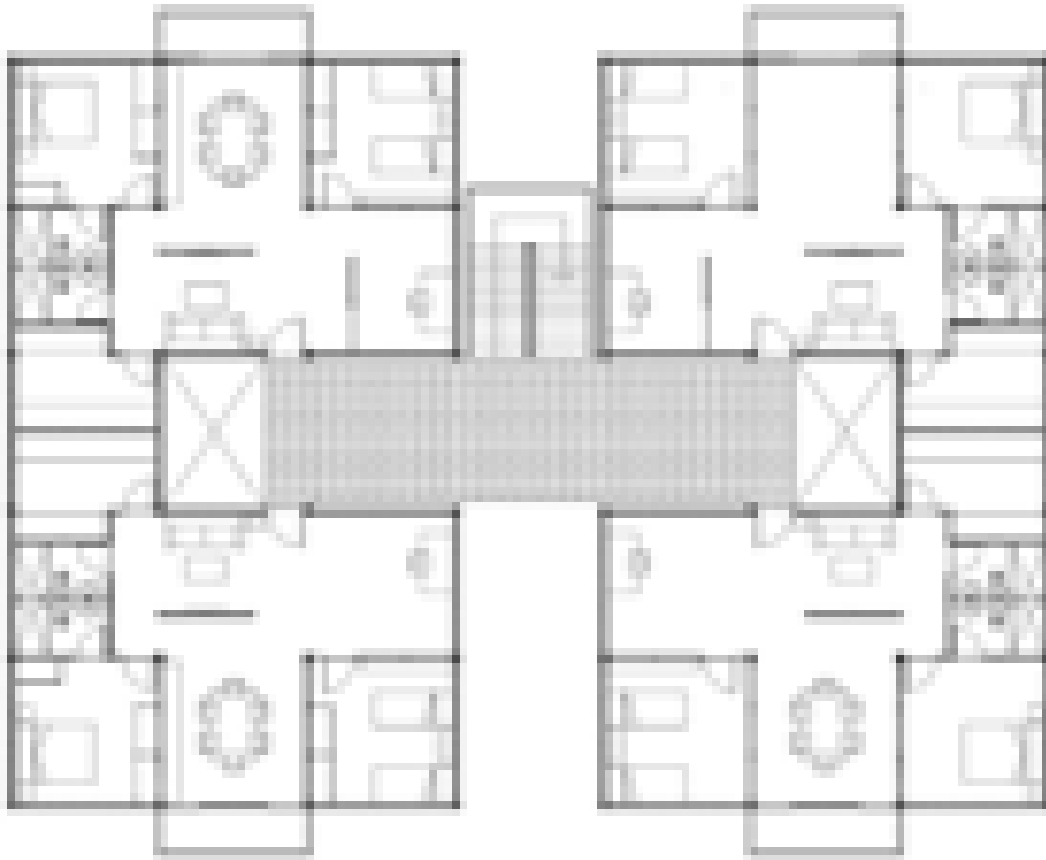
Aplicación de la tecnología en conjunto de viviendas . Fuente: Elaboración propia, 2013.
